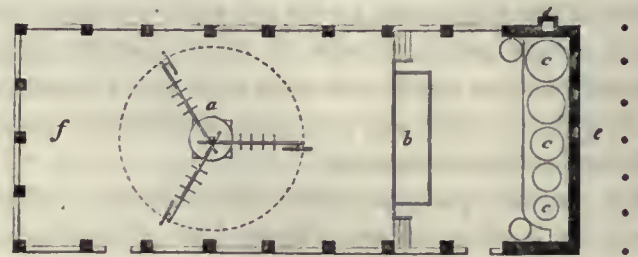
Plan de l'usine proprement dite (*Casa do Engenho*).
